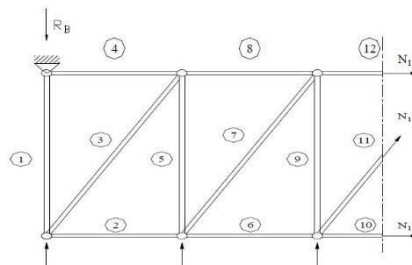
Simplificação do contraventamento da cobertura para vida de Pratt, com a fachada de empena a compressão.
